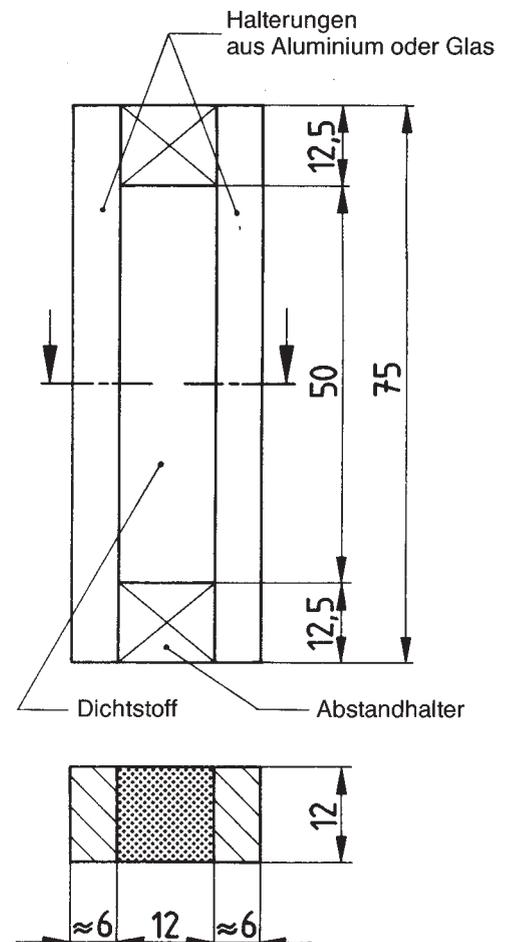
Probekörper mit Halterungen aus Aluminium oder Glas
